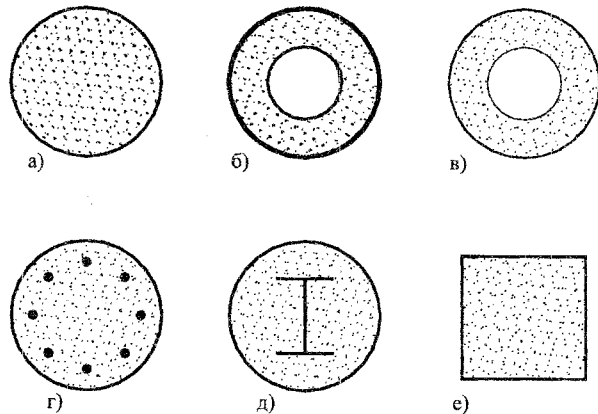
Характерні перерізи труботетонних елементів:
